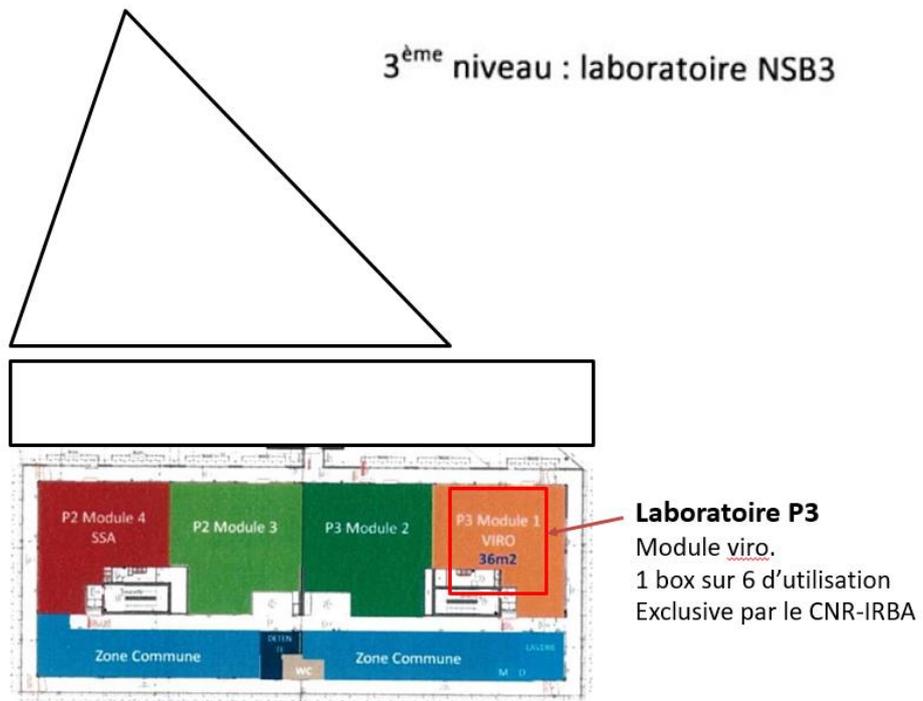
Plan des locaux du CNR-IRBA sur le site IHU (niveau 3)
